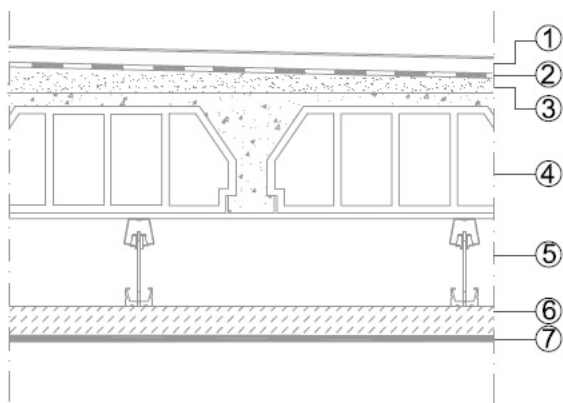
Pormenor construtivo do pavimento nas zonas húmidas da fração destinada à habitação.
